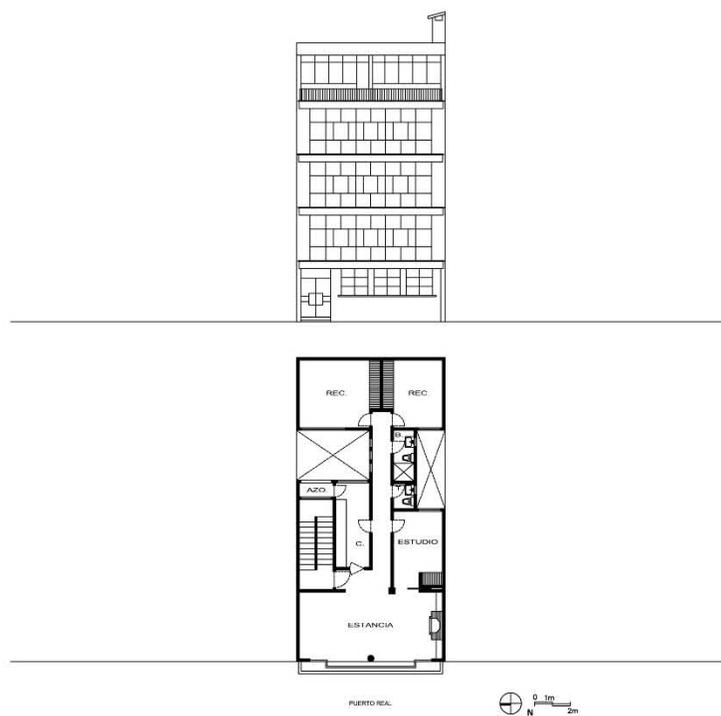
Fachada y planta del edificio ubicado en Puerto Real núm. 38
